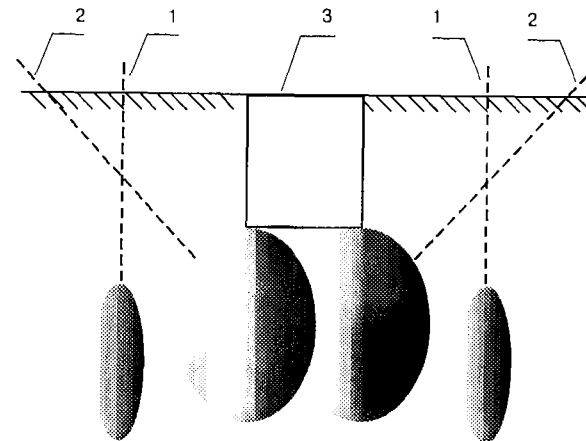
Поэтапное укрепление грунта основания фундамента
